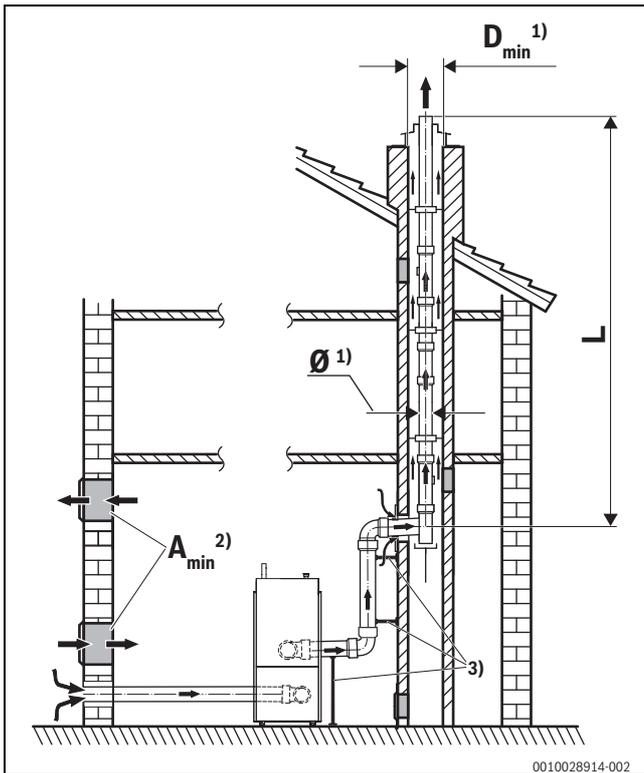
Wirksame Höhe der Abgasleitung, im Schacht, Variante 2
